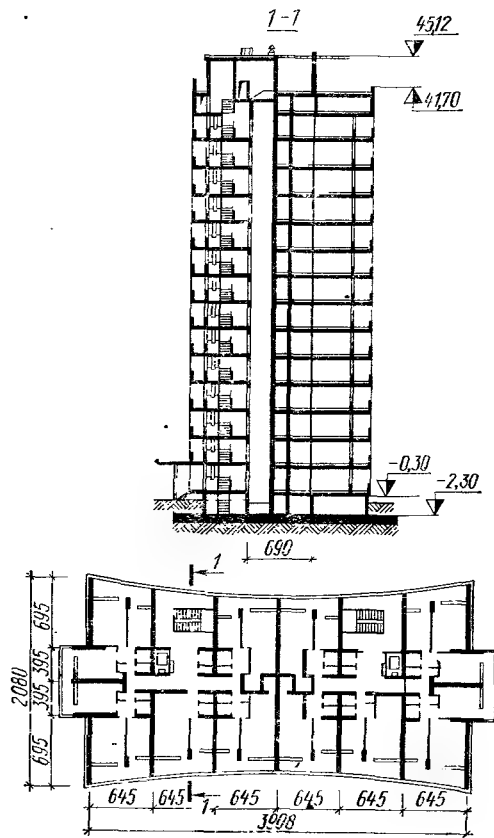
Жилые 16-этажные здания, построенные в г. Сочи в скользящей опалубке (разрез и план)
